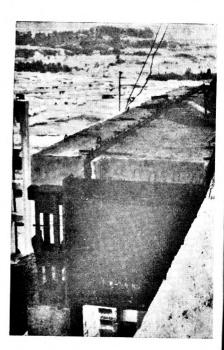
Производство работ по устройству сборно-монолитного настила перекрытия
